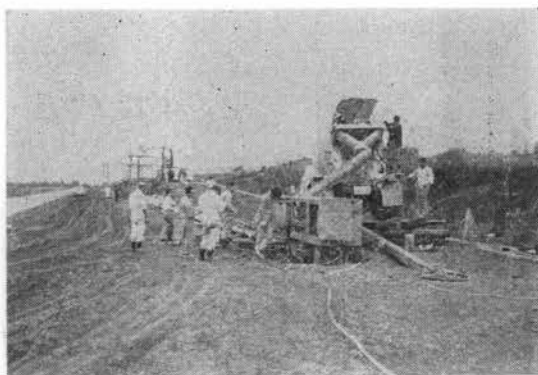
コンクリートポンプの作業テスト (土木用コンクリート)
